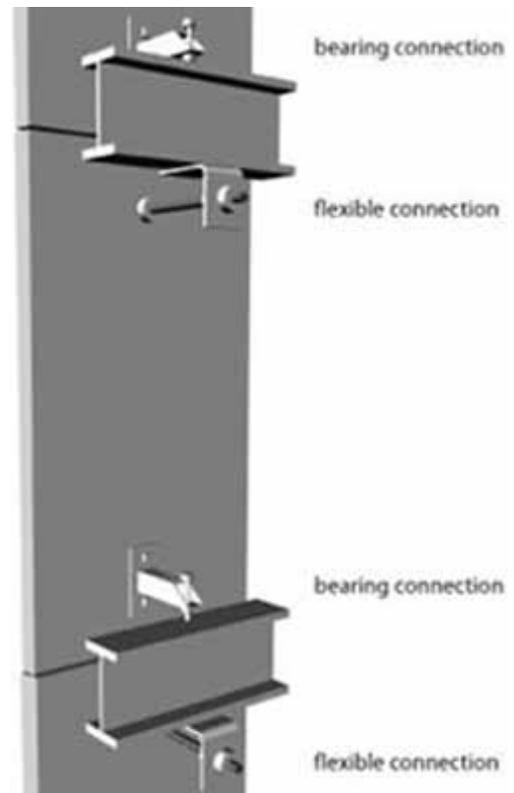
Neste arranjo, a fixação flexível ocorre na viga do pavimento superior deixando a panel sujeito a instabilidade de caso ela falhe. (ARNOLD, 2009)
